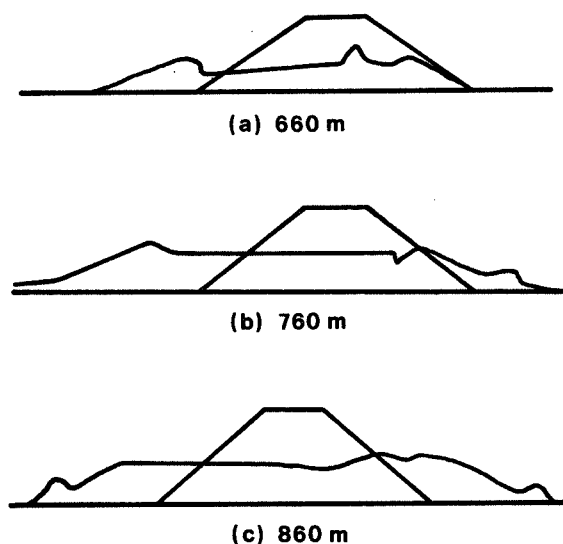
Affaissement constaté sur trois profils du remblai de la voie de
